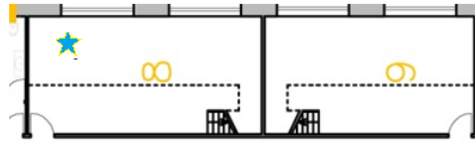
Pianta ufficio 8 – Piano terra. Il posizionamento dei Tinytag è indicato dalla stellina celeste.
